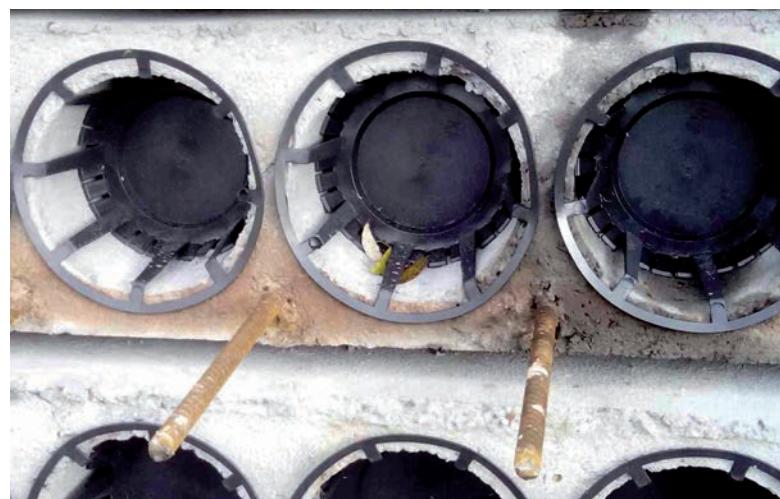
Вигляд торців плит перекриття ПК з випусками арматури і заглушками.
